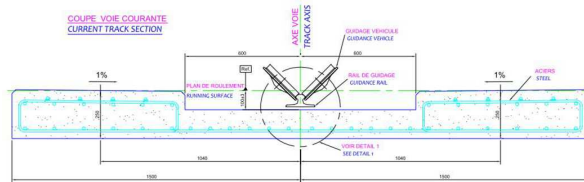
Géométrie du rail de guidage / Guide rail geometry
